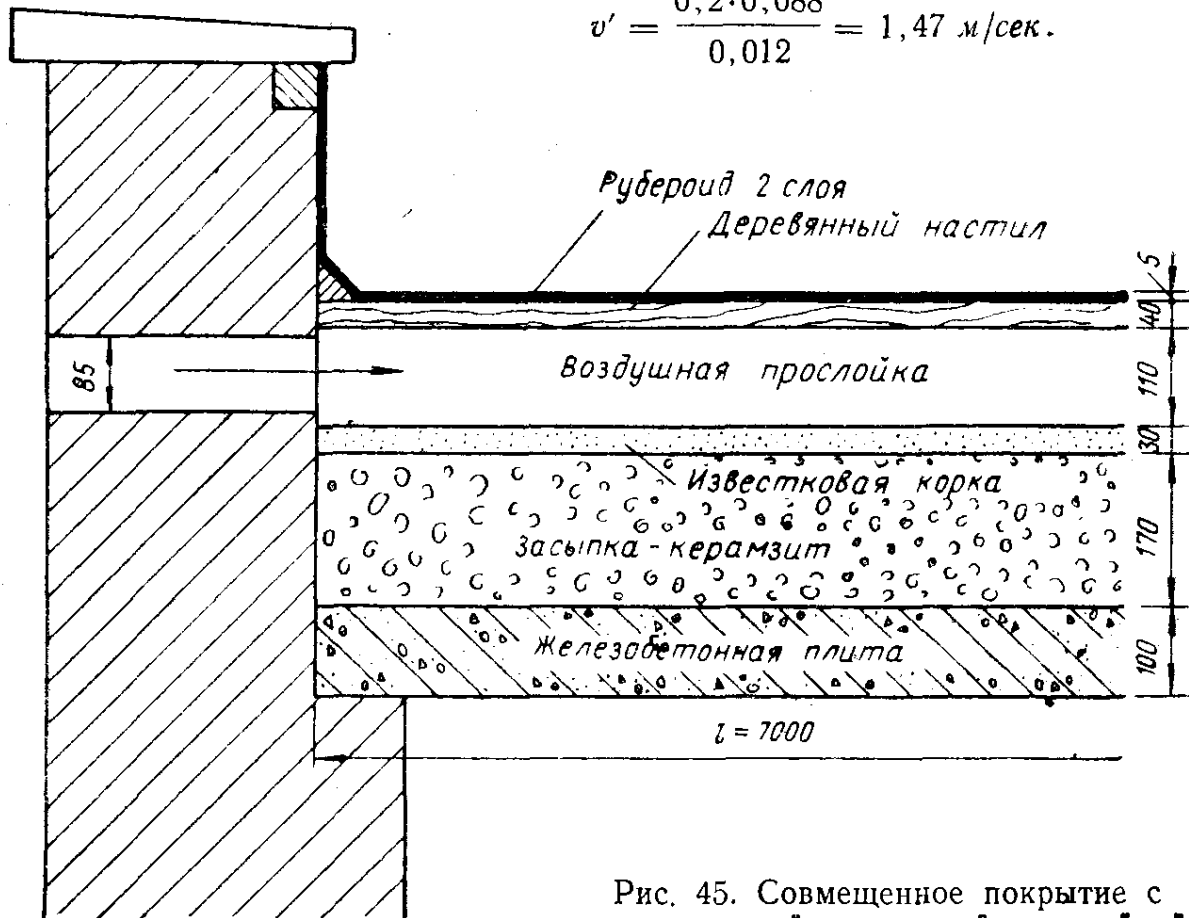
Совмещенное покрытие с вентилируемой воздушной прослойкой
